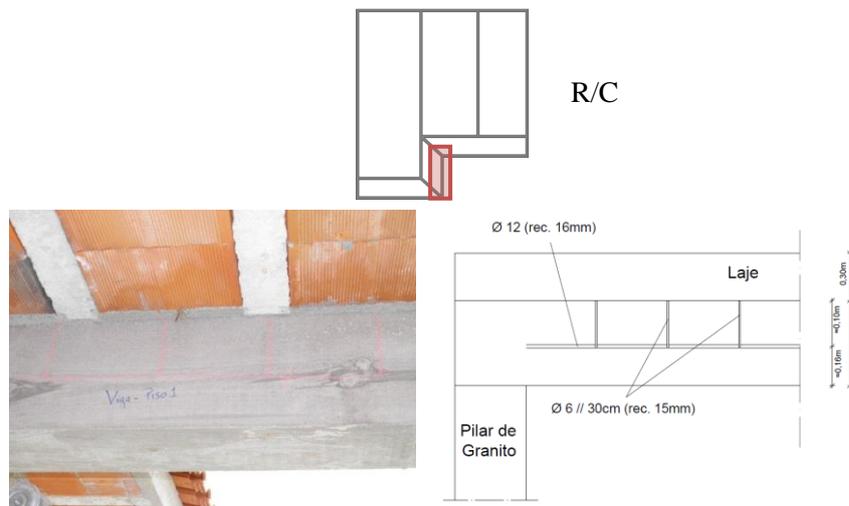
Armadura detectada na Viga V1 R/Chão
